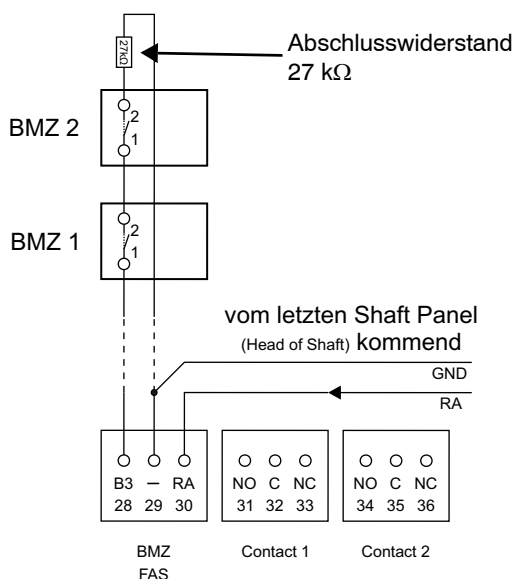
Anschlussplan Kontakt BMZ (Stair Panel)
